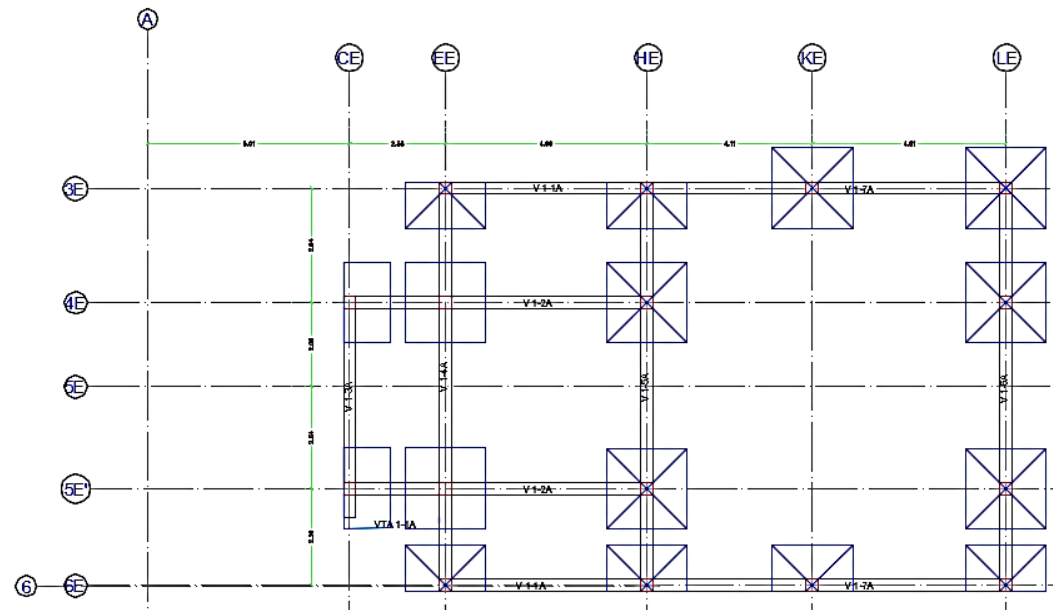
Planta de cimentación zapatas. Fuente: Auto
